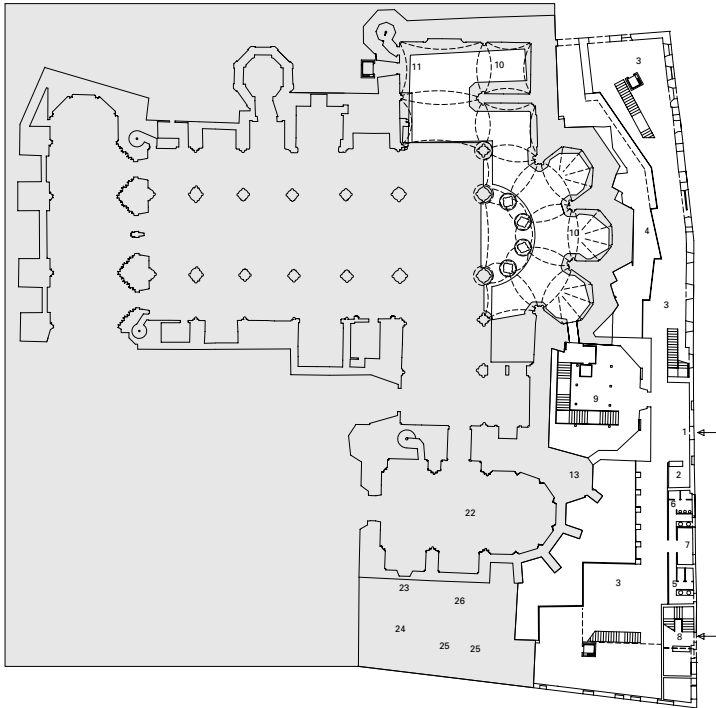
Propuesta de rehabilitación del conjunto con usos de carácter socio-cultural y conservación parcial de la edificación existente. Planta a nivel de la calle Cuchillería y planta baja
